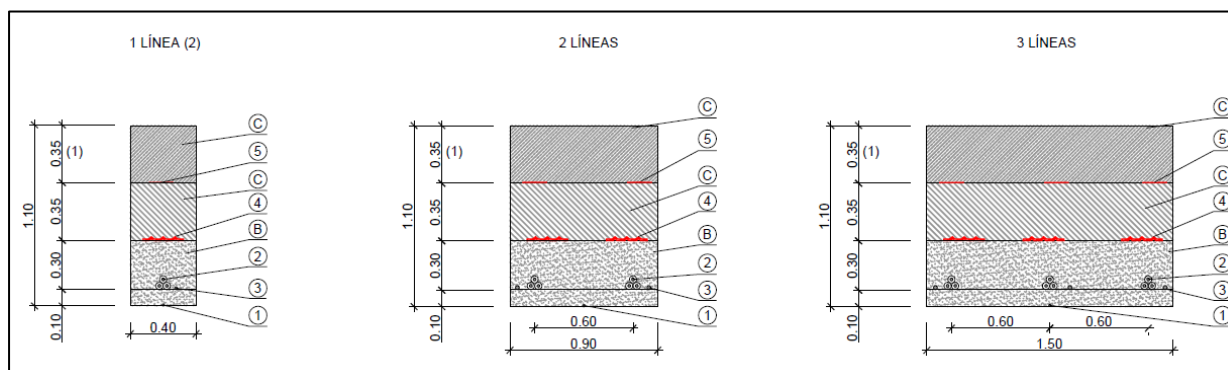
Detalle Sección Canalización. Tipo conductor directamente enterrado
